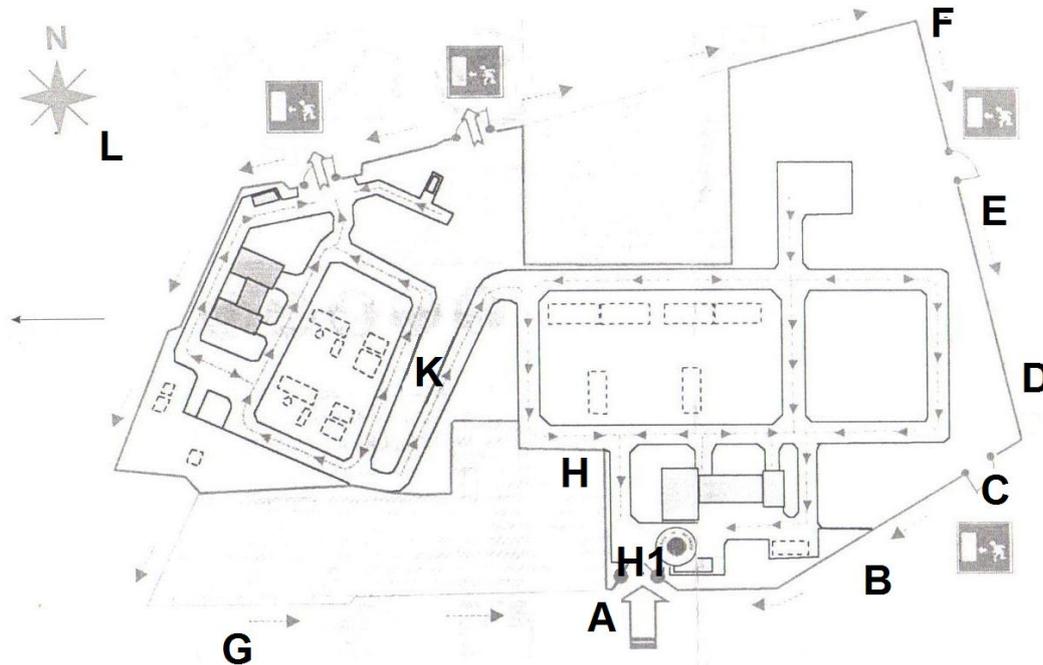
Planimetria semplificata dell'area di studio con individuazione dei punti di misura
